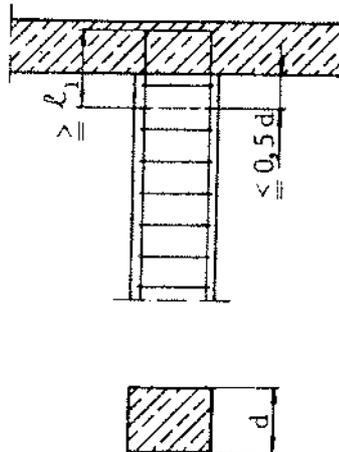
Zona de anclaje de la armadura de columna sin requerimientos especiales con respecto a la adherencia.
